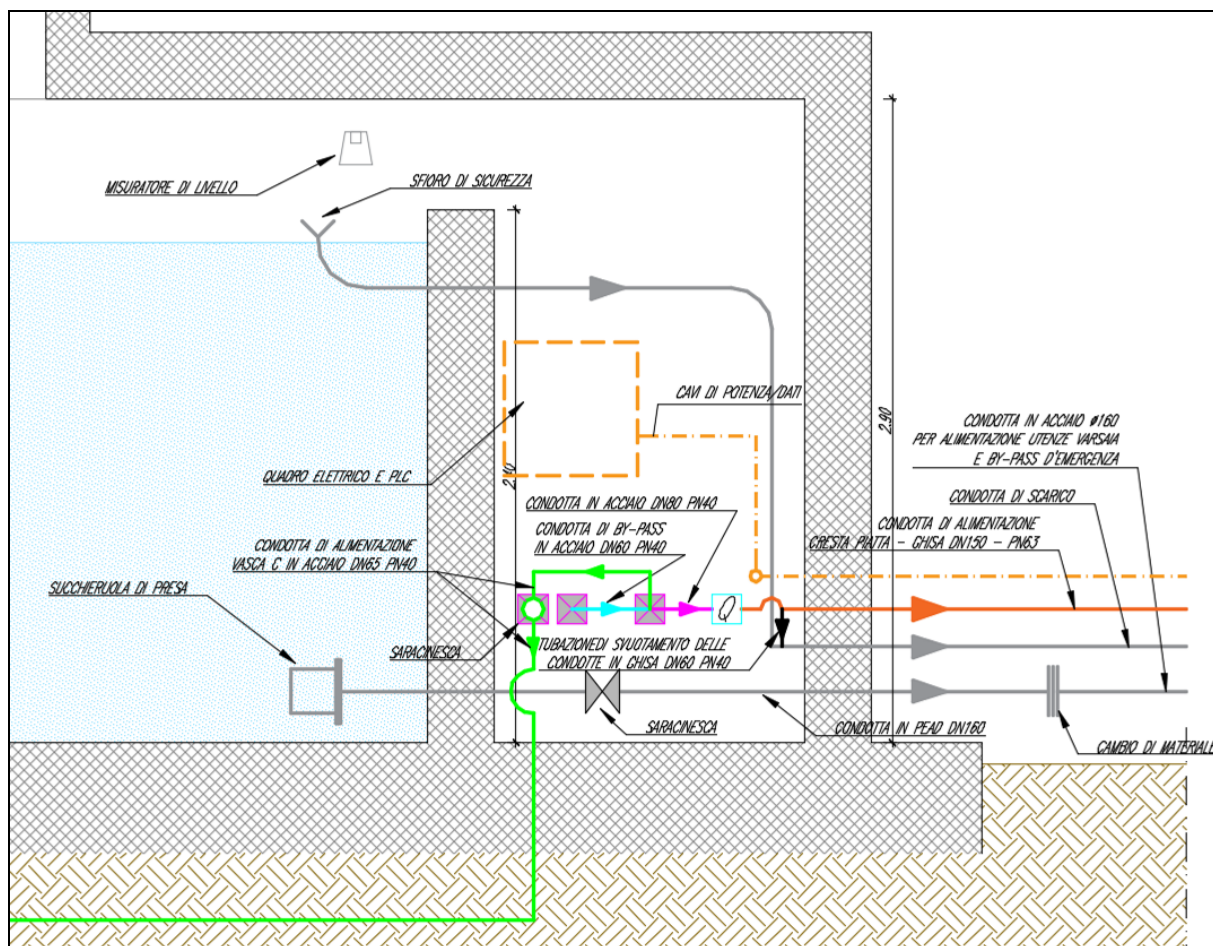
Pianta di progetto del nuovo locale tecnico previsto per alimentare la località Foppiano
